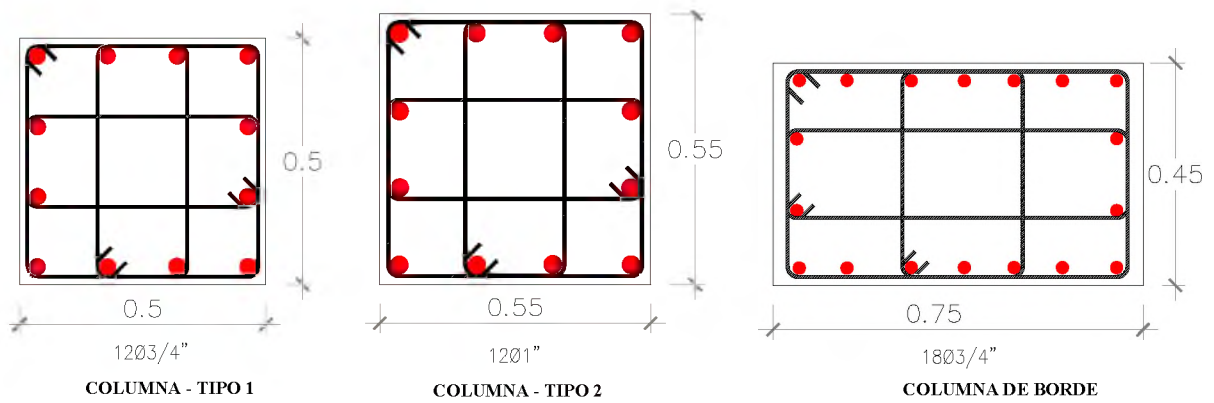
Tipo de columnas de concreto armado en el edificio de ocho niveles
